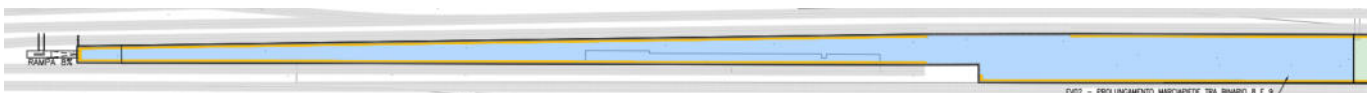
Prolungamento marciapiede binario 8 e 9 – Stralcio planimetrico
